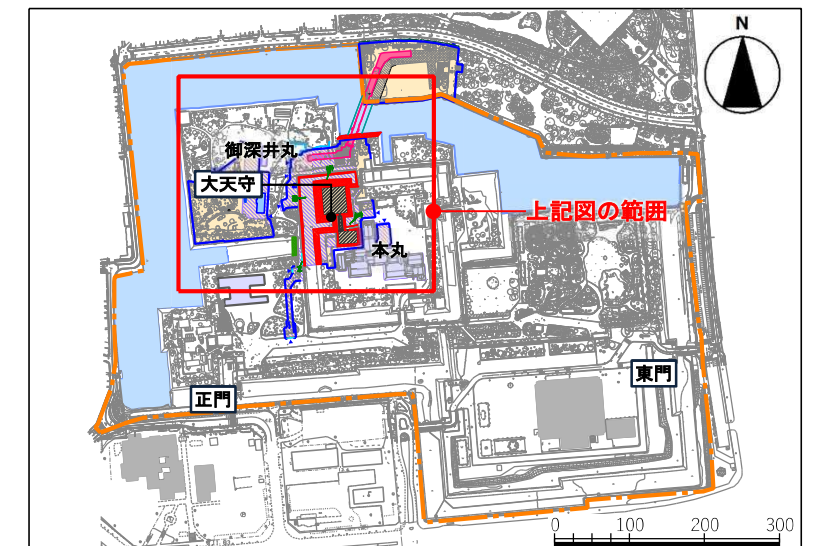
石垣の保存及び安全対策工事時の平面図(敷地全体)
